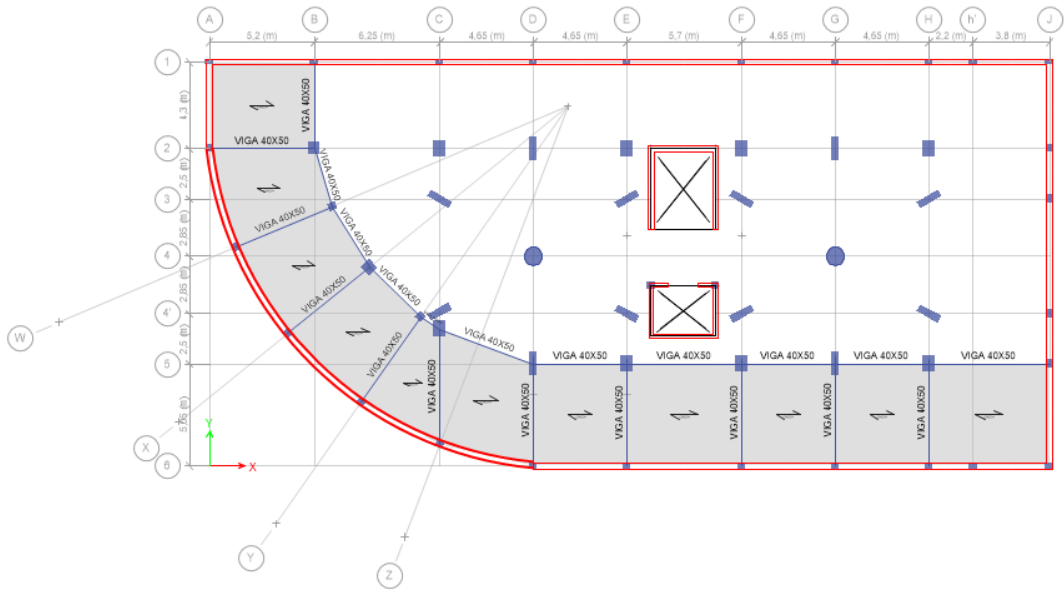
Planta nivel 0.00 m Edificio Silva Núñez
